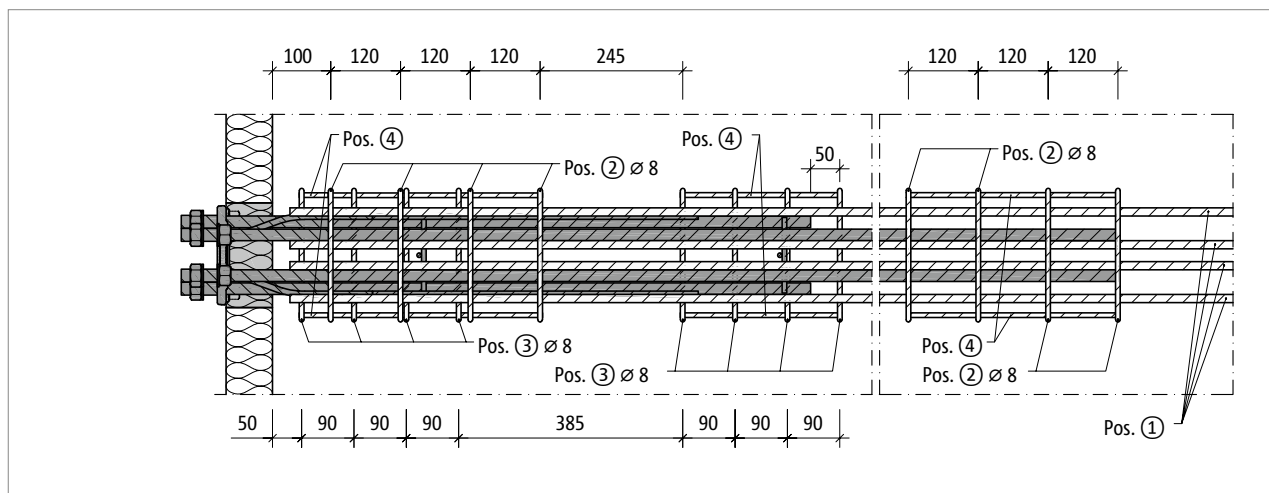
Schöck Isokorb® T type SK-MM2 : renforcement sur site, plan de base
